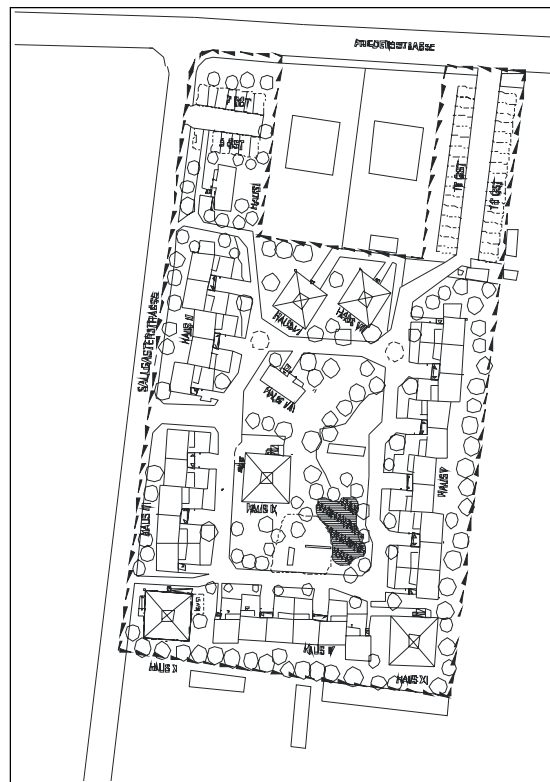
Lageplan Hof- und Gruppenbebauung
